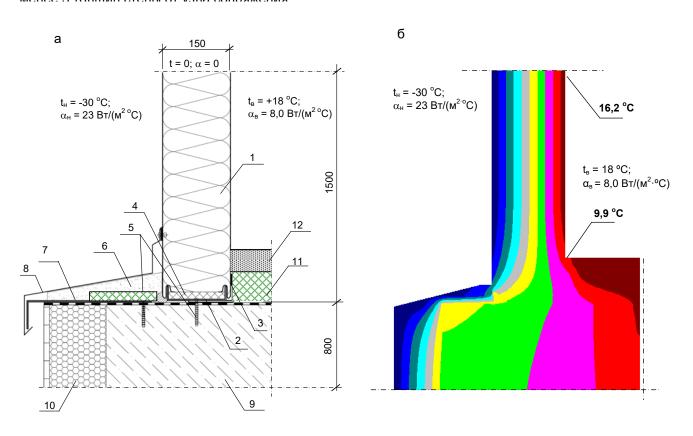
Расчетная схема (а) и результаты расчета температурного режима (б) узла сопряжения наружной стены с цоколем здания: 1 – стеновая панель; 2 – опорный элемент; 3 – фахверковый ригель (металл); 4 – теплоизоляция; 5 – дюбель-гвоздь; 6 – цементно-песчаный раствор; 7 – крепеж стенового нащельника; 8 – стеновой нащельник; 9 – бетон; 10 – теплоизоляция цокольного узла; 11 – теплоизоляция пола; 12 - бетонная стяжка пола
